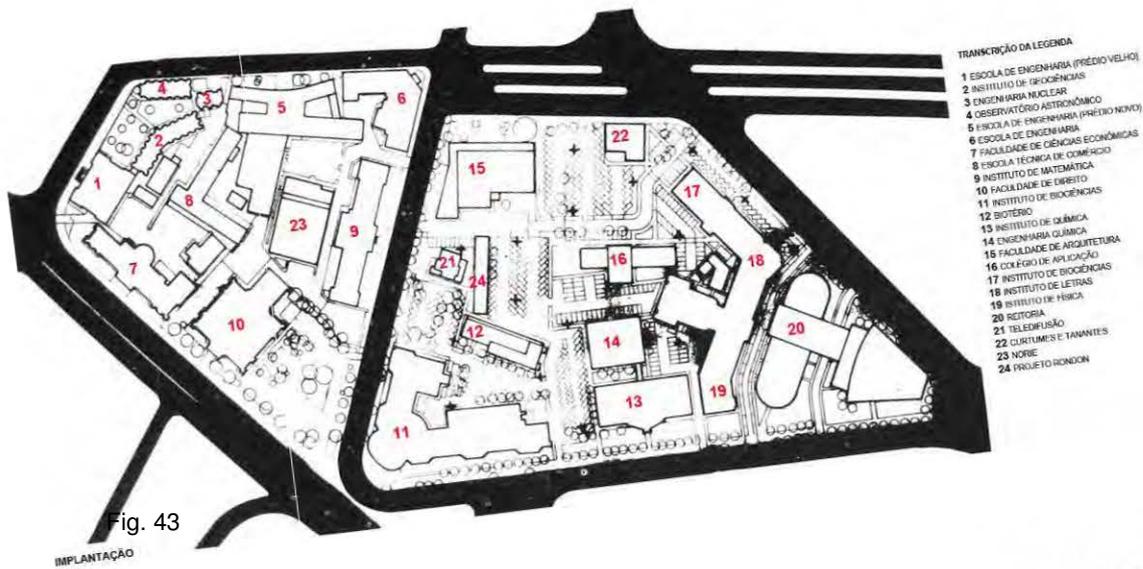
Projeto Centro Cultural: planta geral, levantamento da situação. Cyrillo Severo Crestani, 1986.
